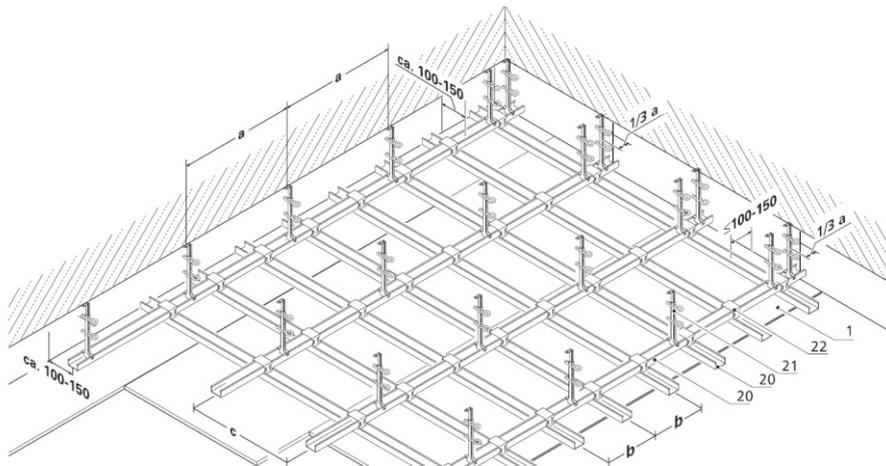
Abgehängte Decke mit Metallunterkonstruktion
